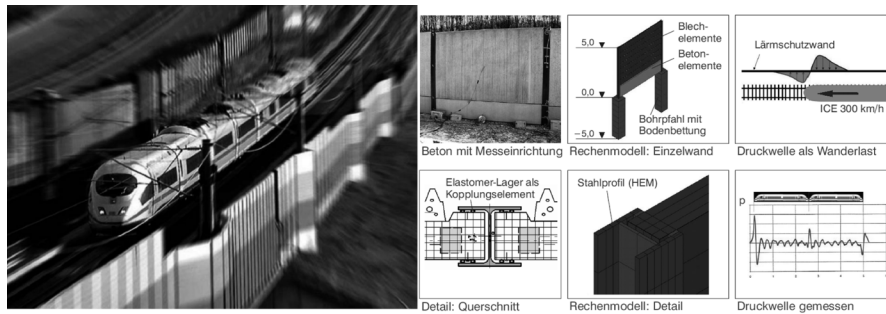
Lärmschutzwände – Ausführung, Modelle, Druckwelle.
